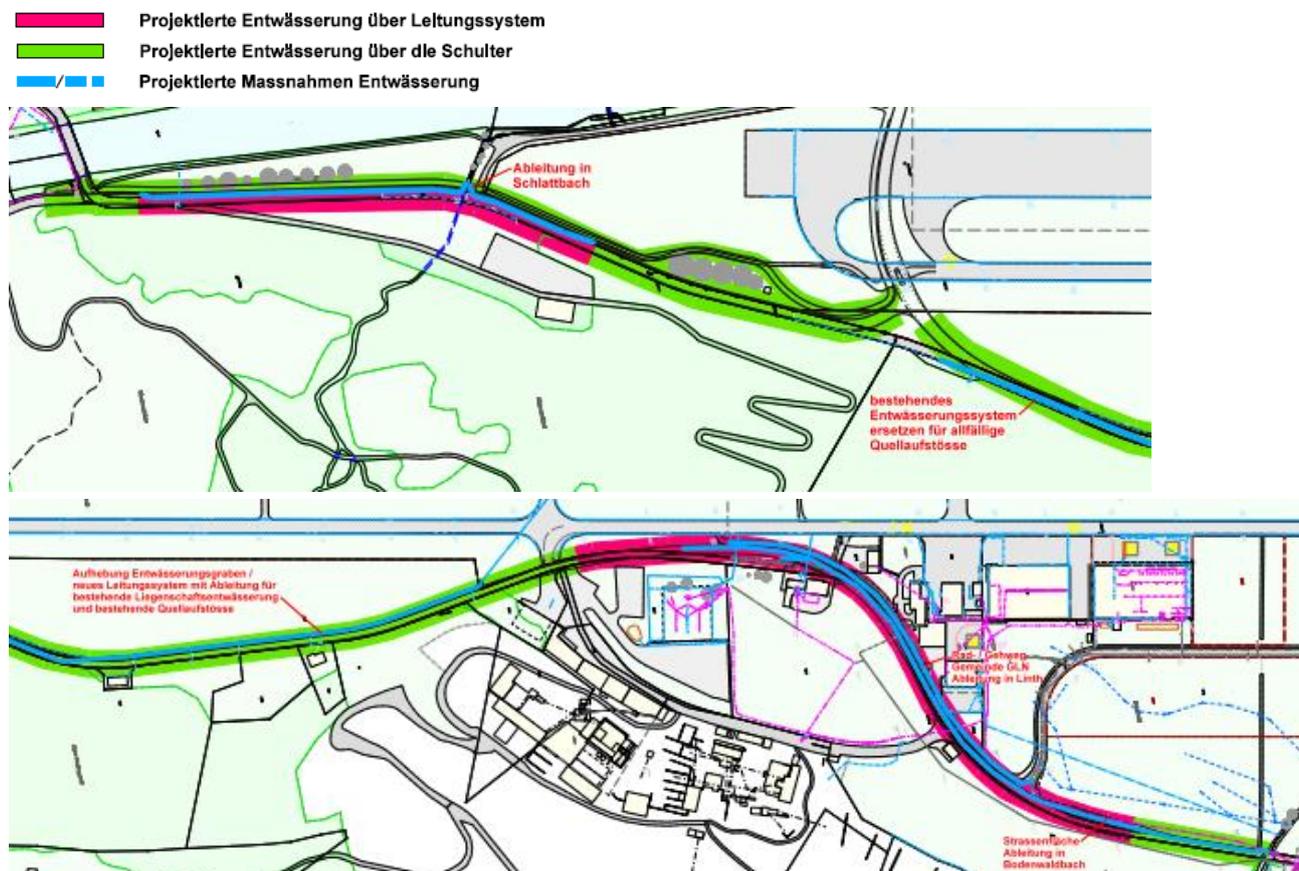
Projektierter Entwässerung, Ausschnitt Plan Nr. 1240.01-03.261, INGE Marty-Geoinfra
